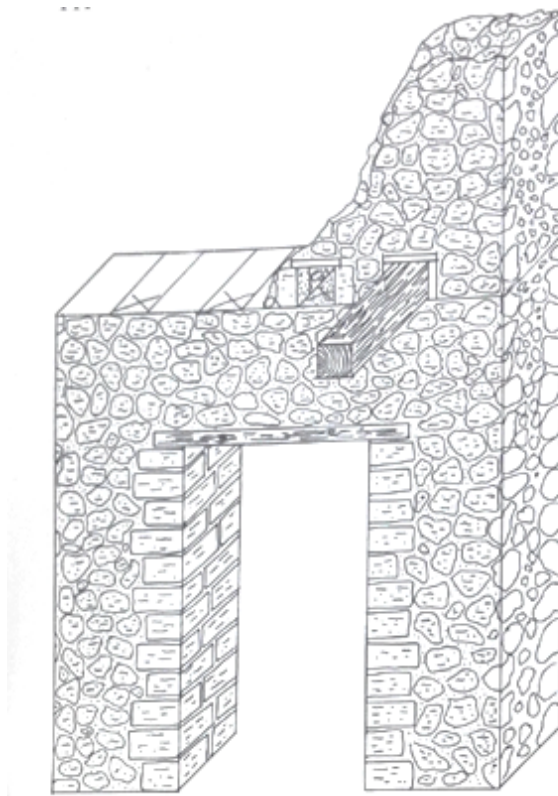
Ipotesica ricostruzione della costruzione di un muro e del solaio (da Ulrich 1996, p. 144, fig. 4).
